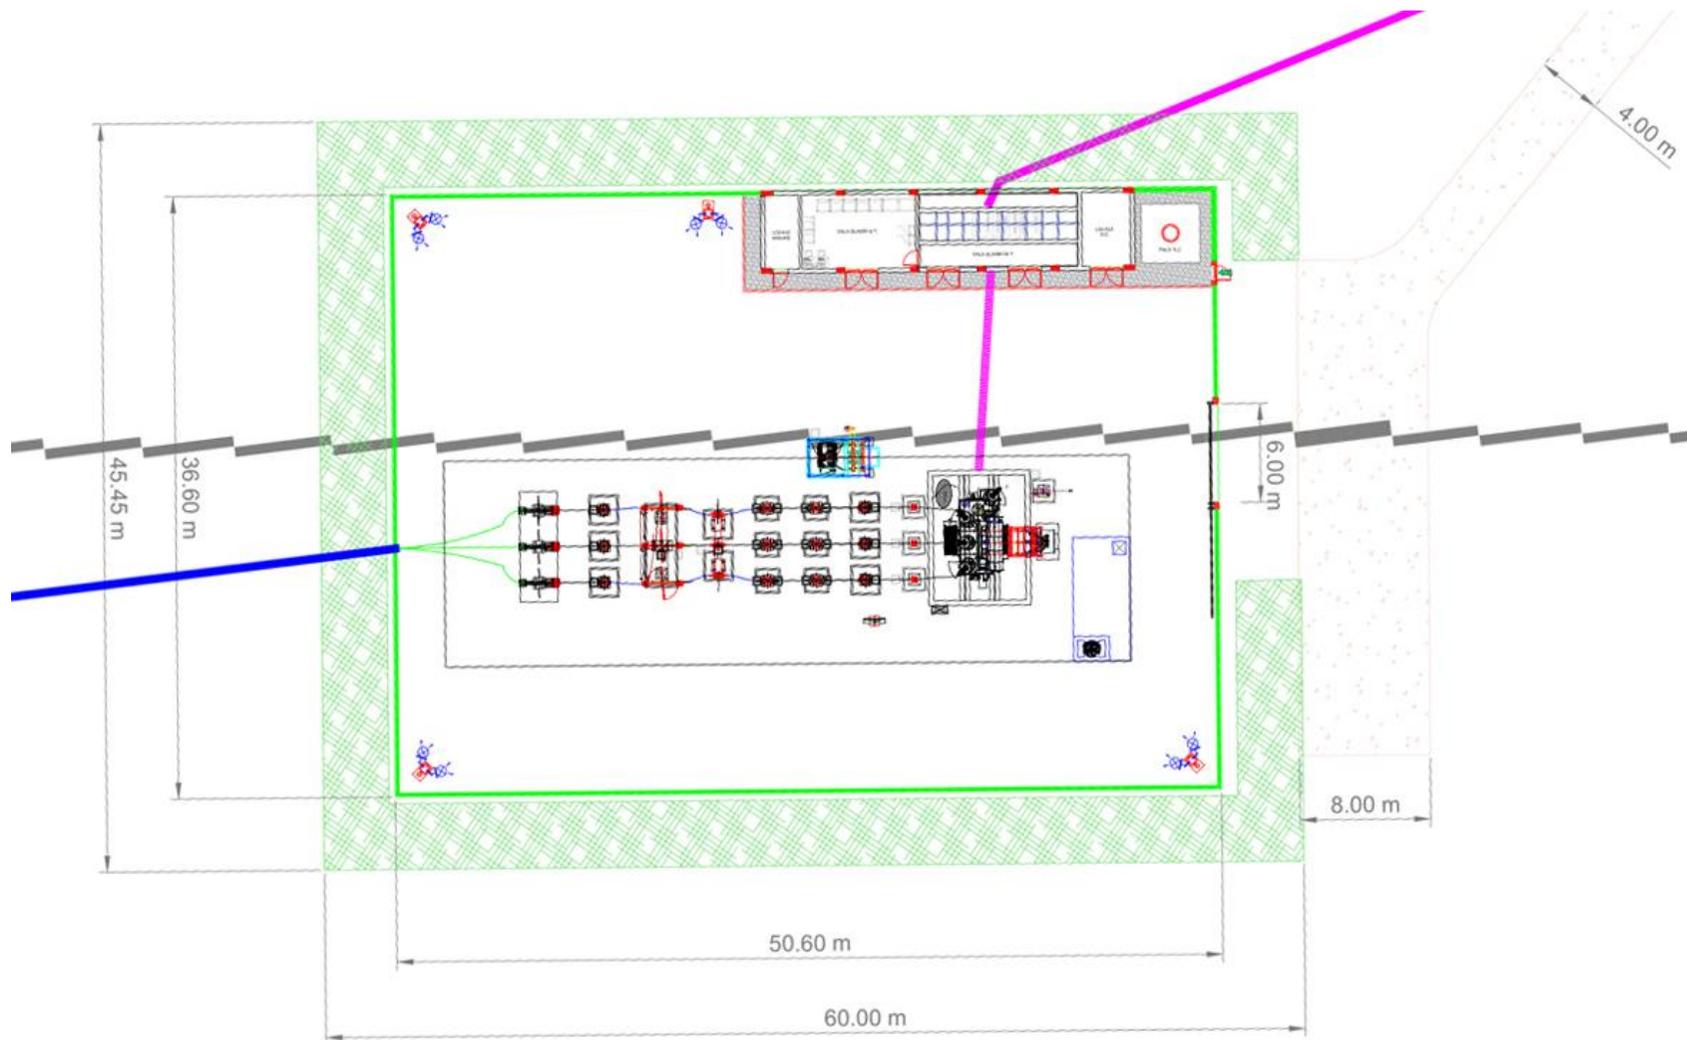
Planimetria della Stazione di Elevazione Utente SEU
